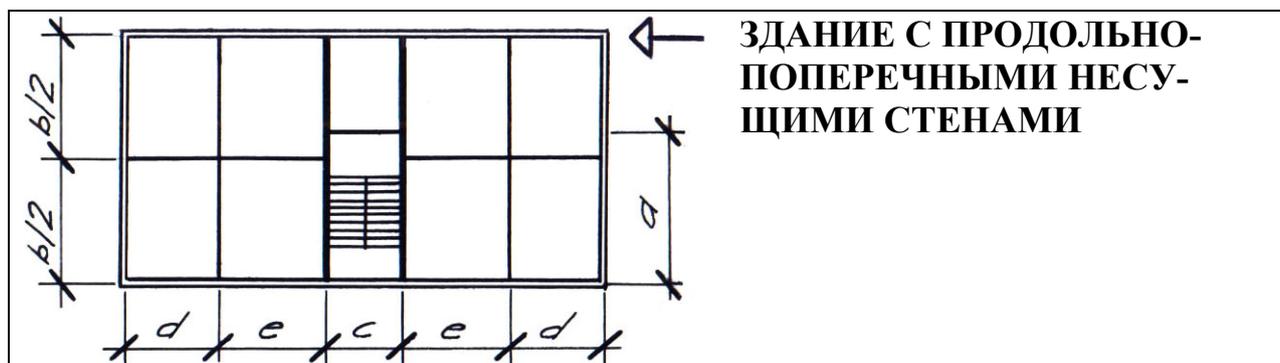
Схема плана здания с продольно-поперечными стенами
